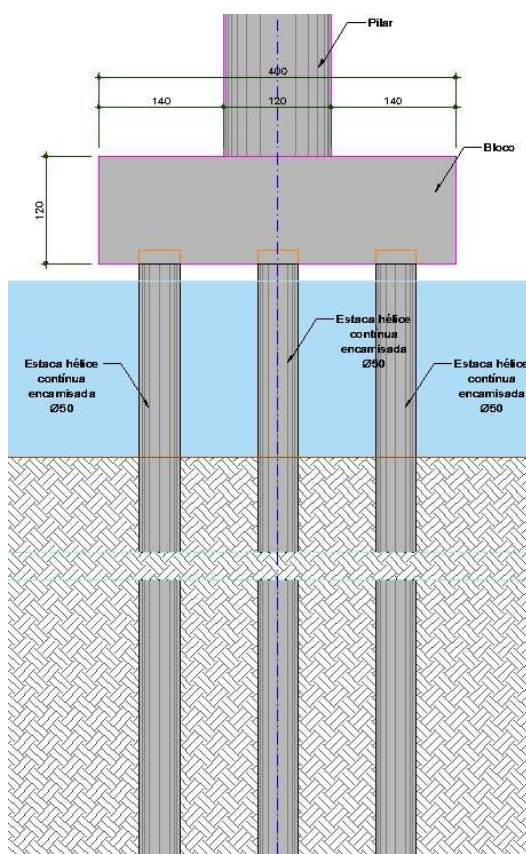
concepção do bloco sobre estacas e seu pré-dimensionamento.
